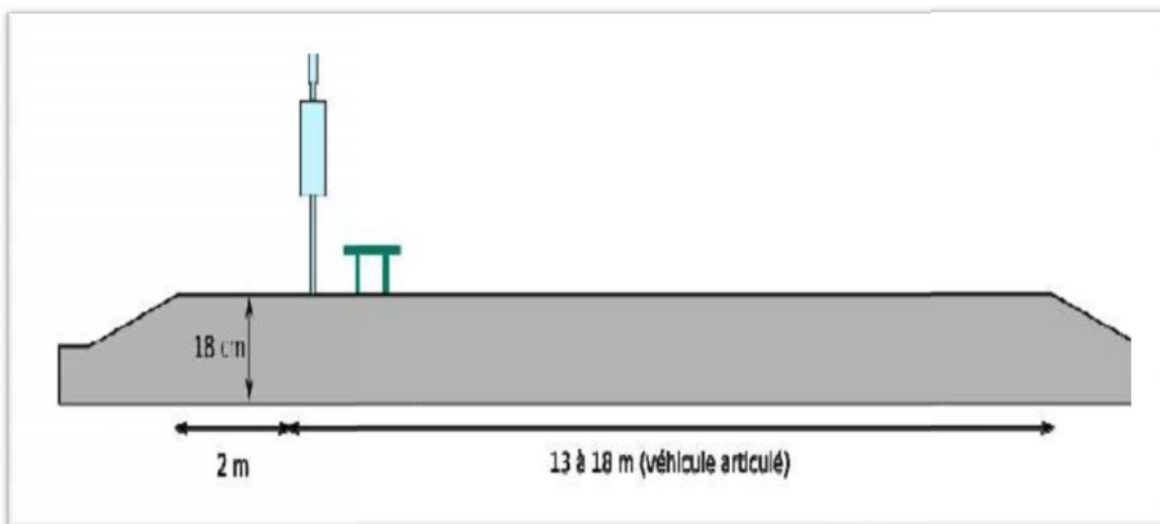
Profil en long d'un point d'arrêt accessible, avec poteau
